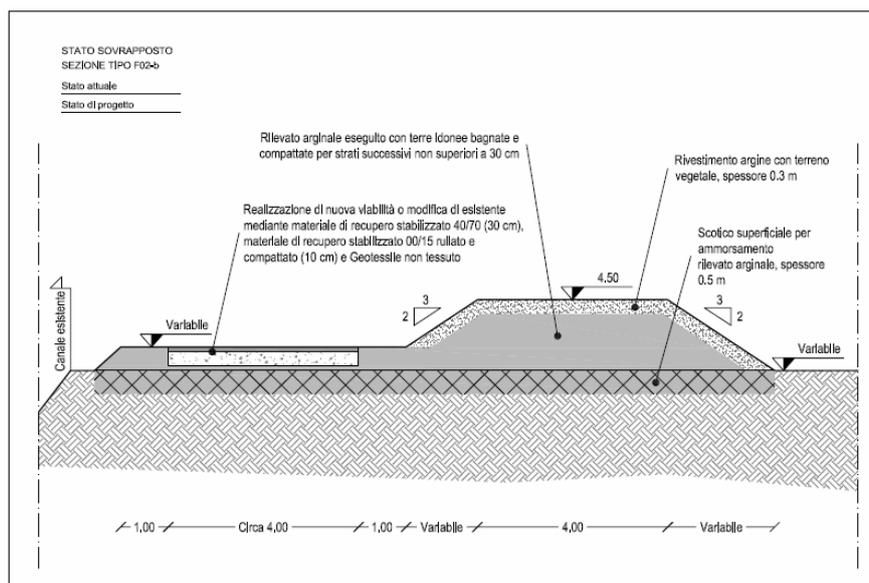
SEZIONE TIPO ARGINE - TRATTO F02
